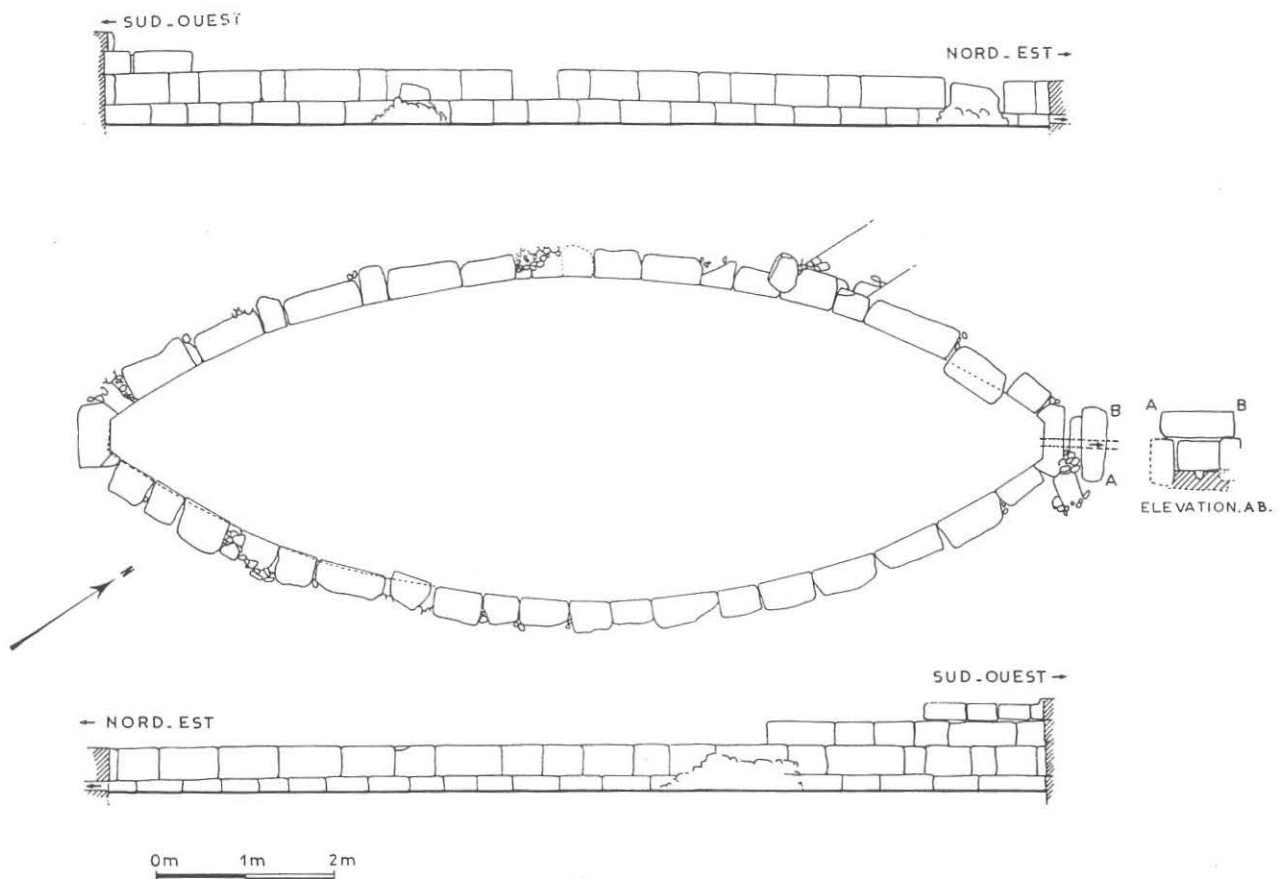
Plan et élévation du bassin à la Pâturage du Couvent.
